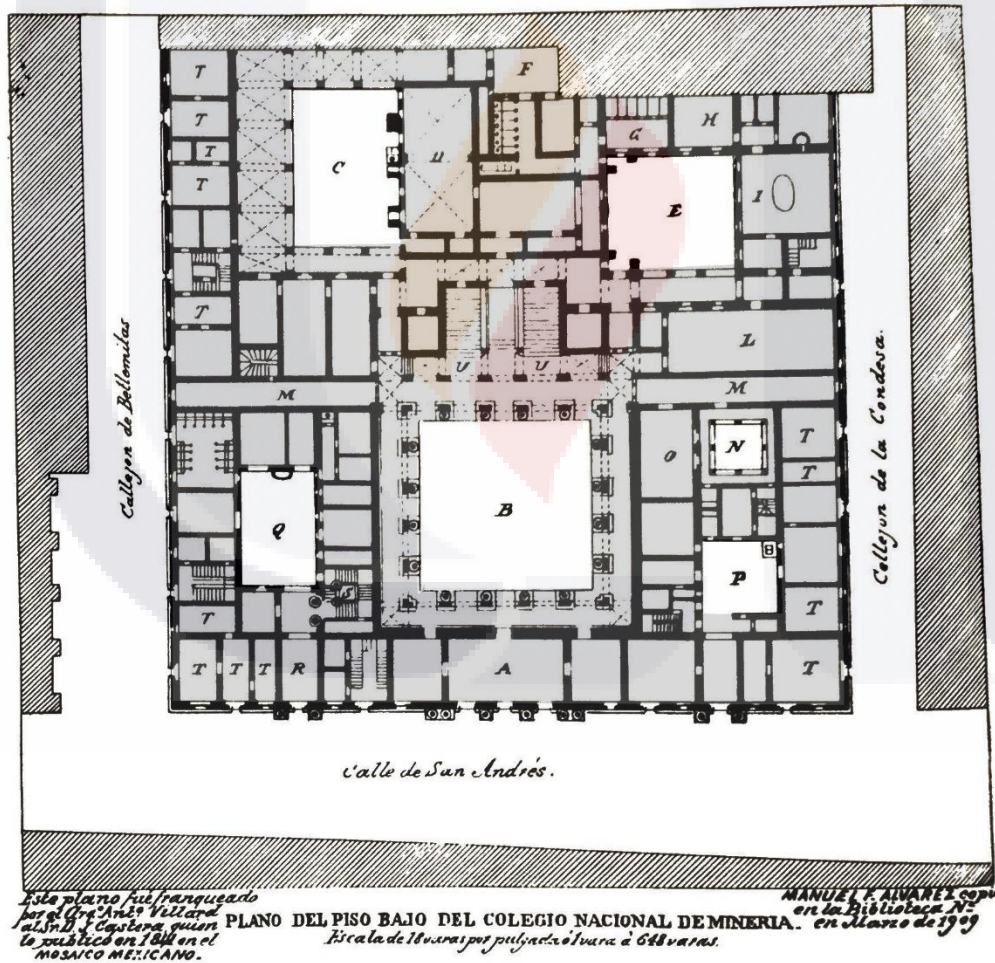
Planta baja del Colegio de Minería de la Ciudad de México, proyectado por el Arquitecto Manuel Tolsá. Nótese la distribución interior basada en núcleos alrededor de patios. Fuente: (Sánchez, 1977, pág. 88).
